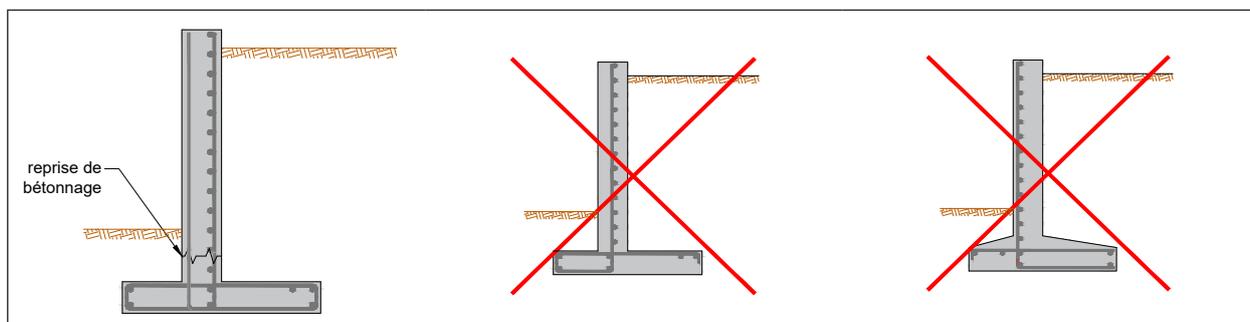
Exemple de ferrailage des murs de soutènement de type 6
